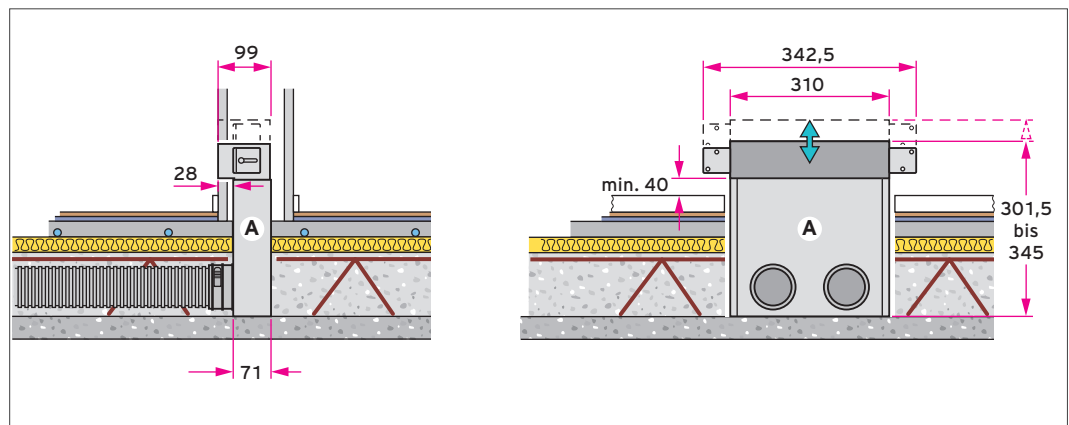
Rechteckiger Luftauslass, Wandmontage - Verlegung in der Rohbetondecke
